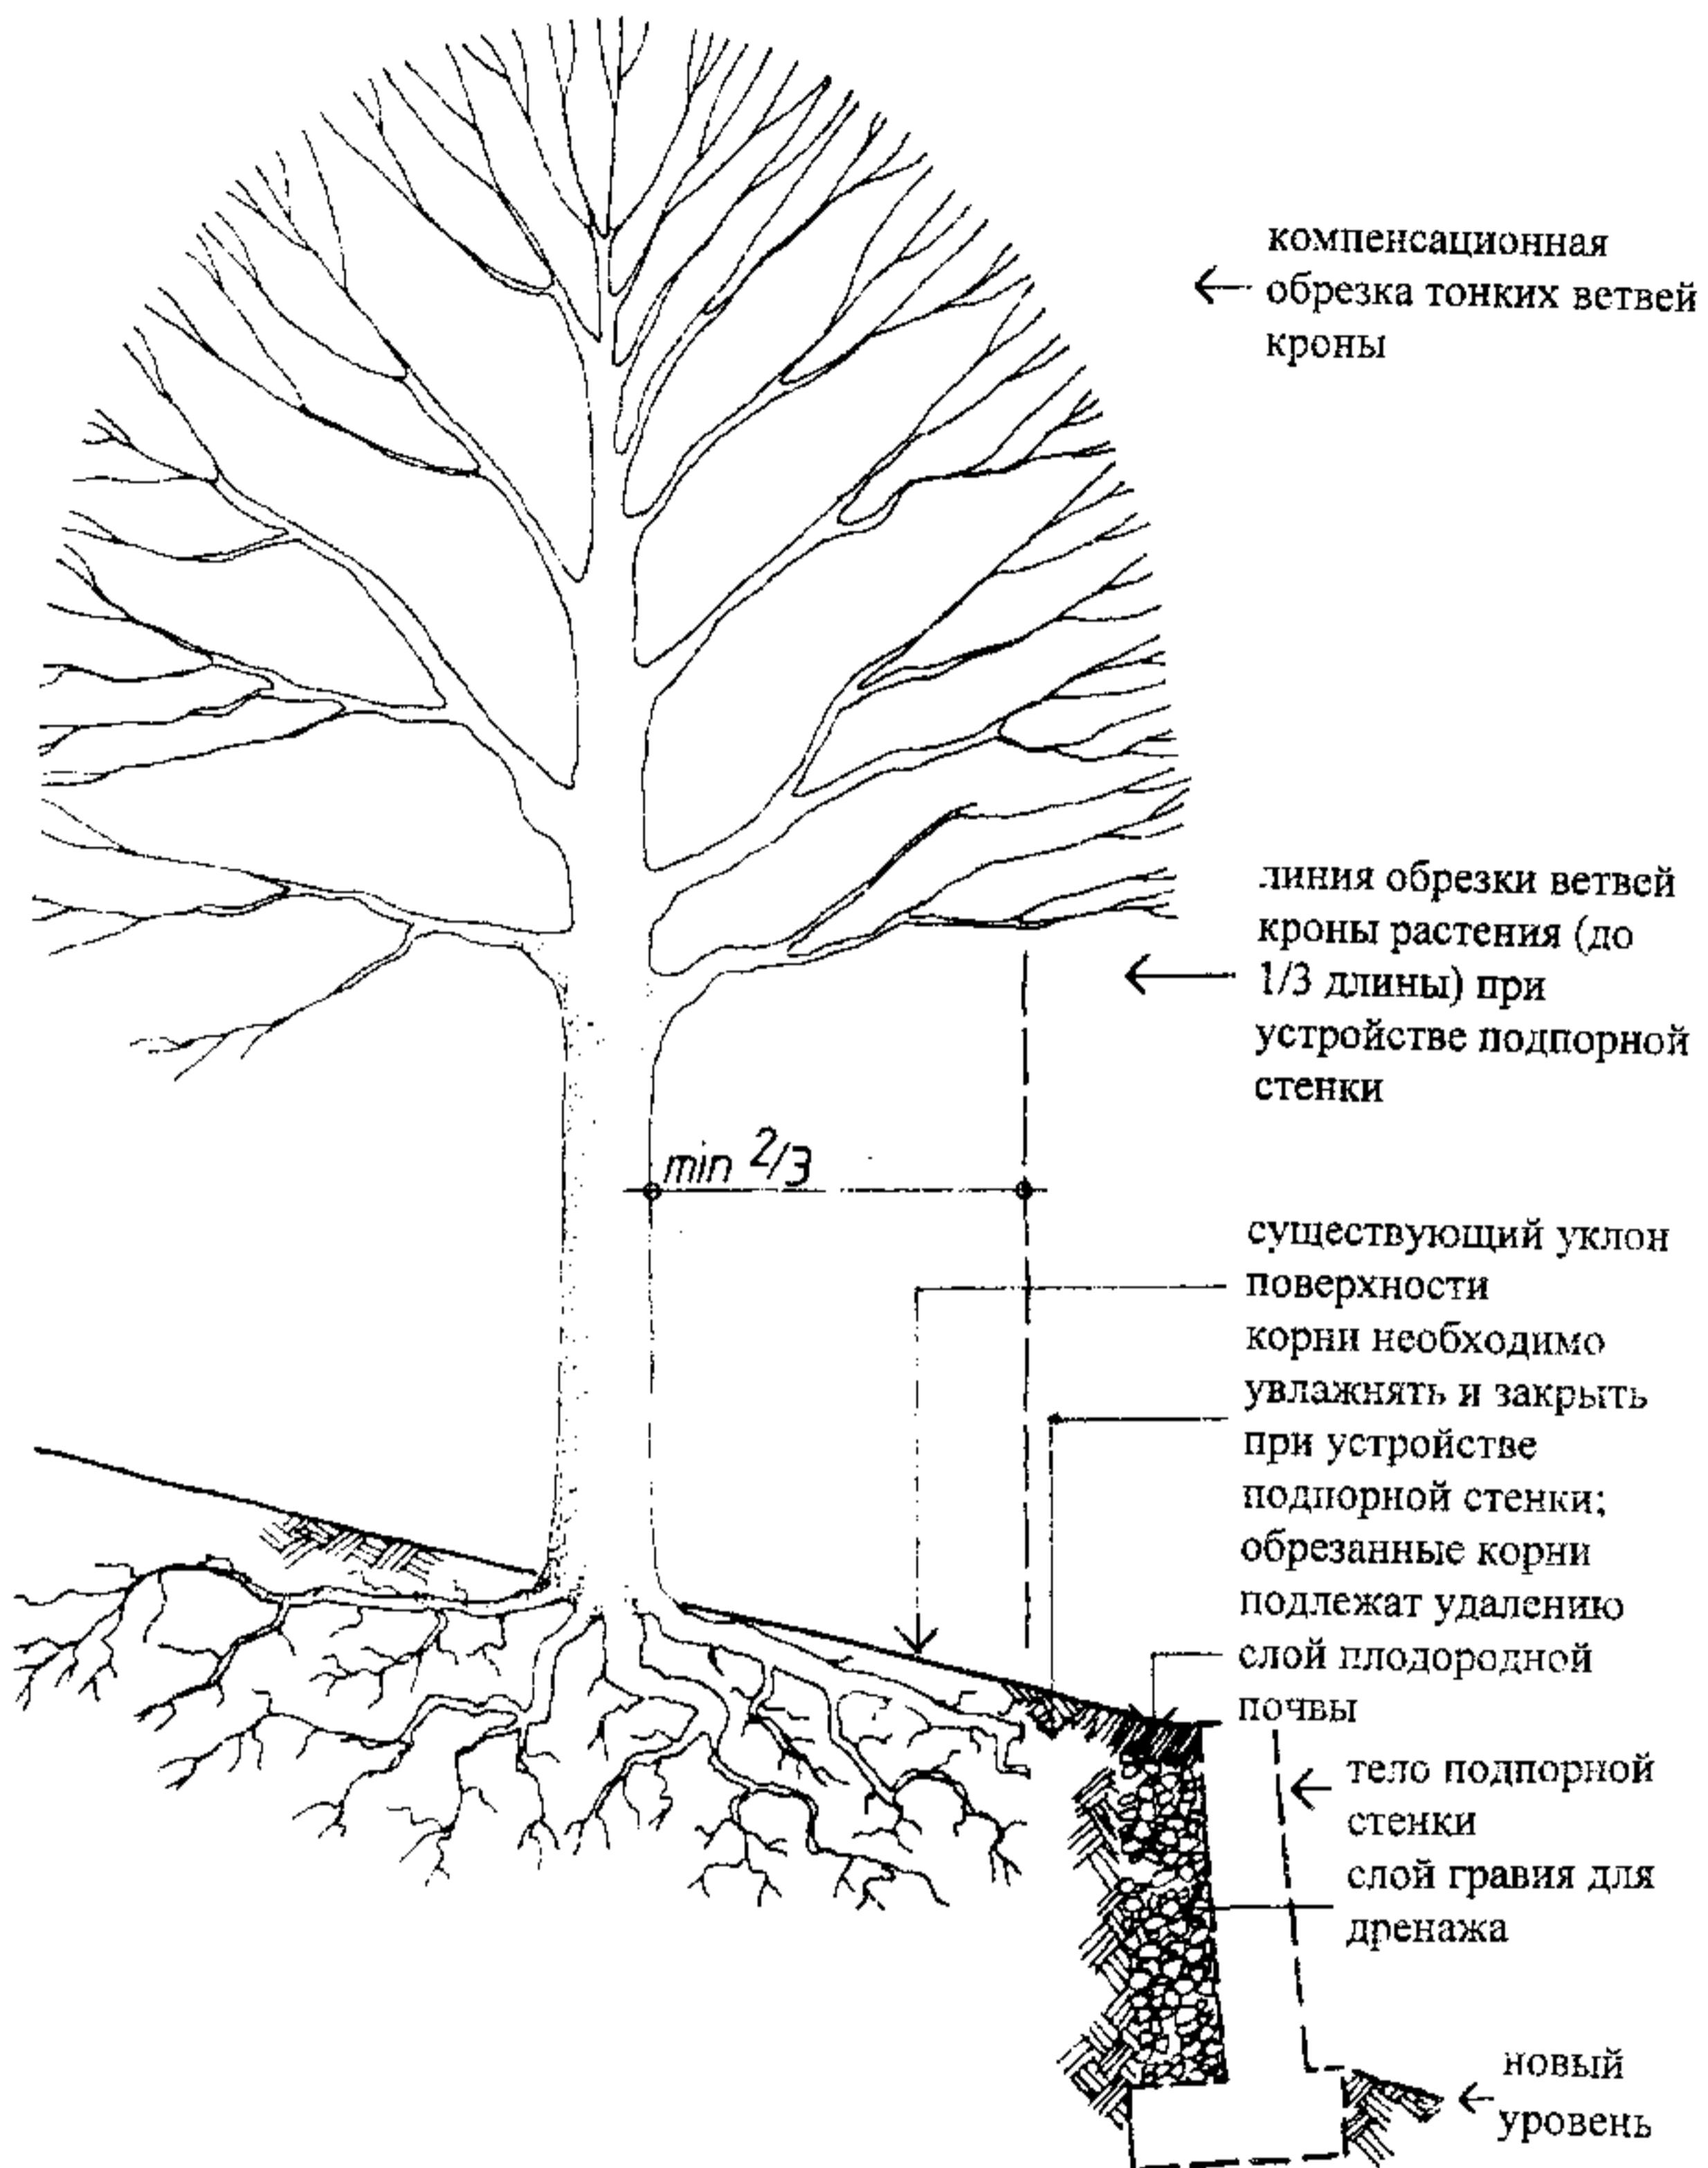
Защита дерева на склоне с помощью подпорной стенки
